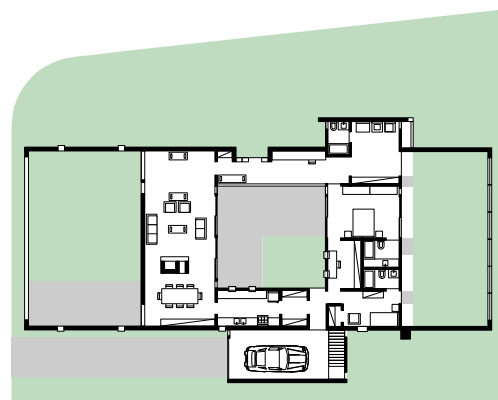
Planta baixa da casa do arquiteto, de autoria de Josep Lluís Sert, 1957. Fonte: elaborado pelo autor.
